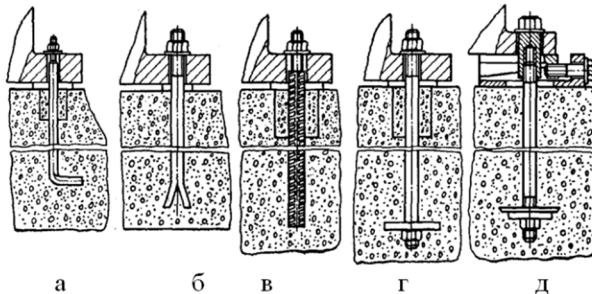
Глухі або залитні фундаментні болти.
